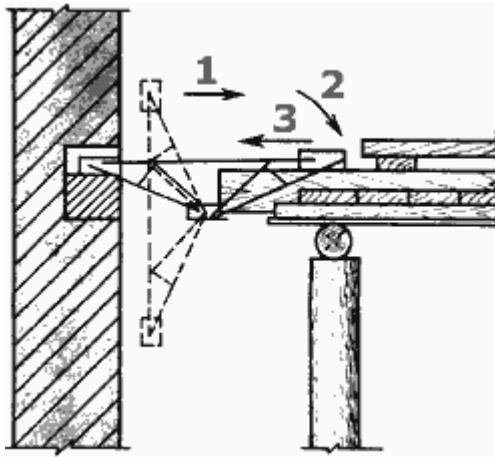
Схема наращивания балки перекрытия (цифрами показана последовательность операций).
